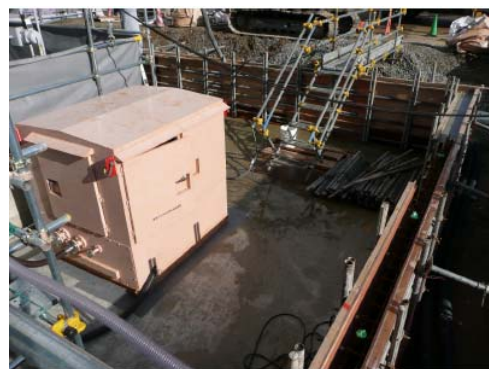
防火水槽の埋設配置状況(手前の砂利部)
